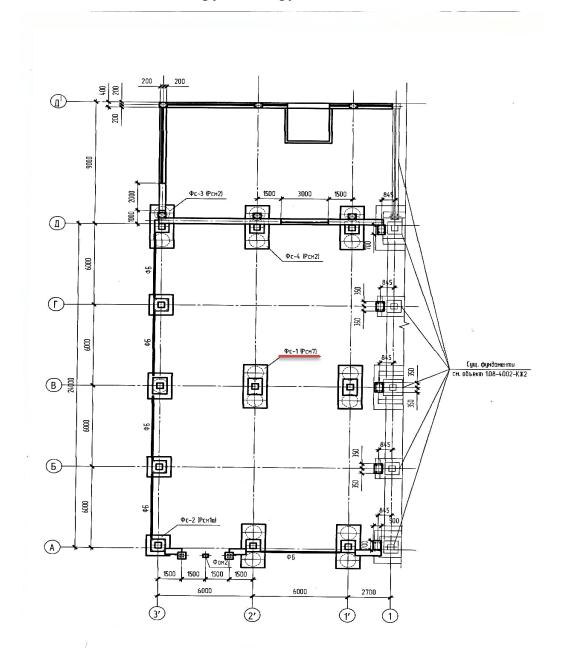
Схема расположения рассчитываемого фундамента
